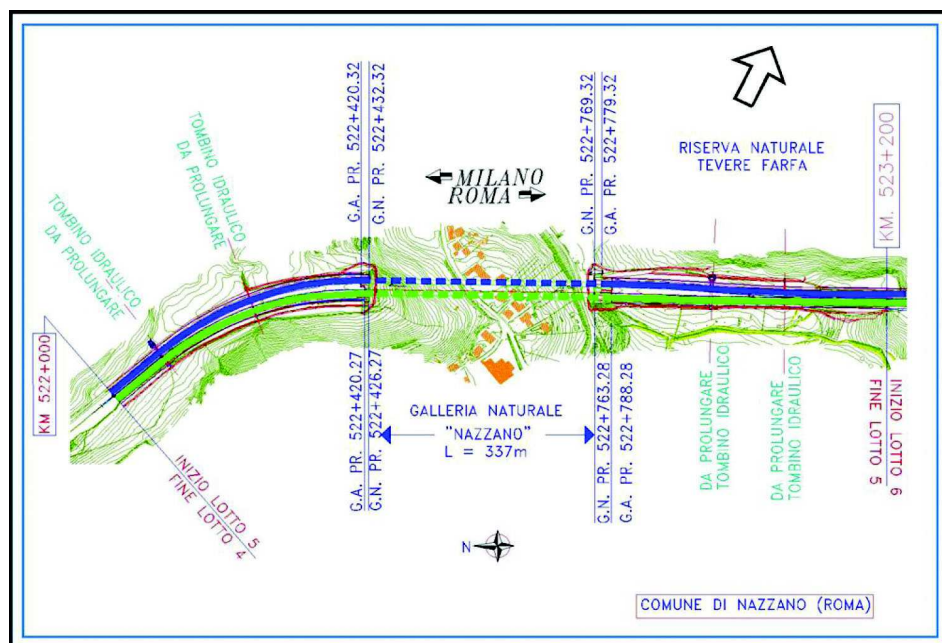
Planimetria del Lotto 5 della Tratta Orte-Fiano Romano.
